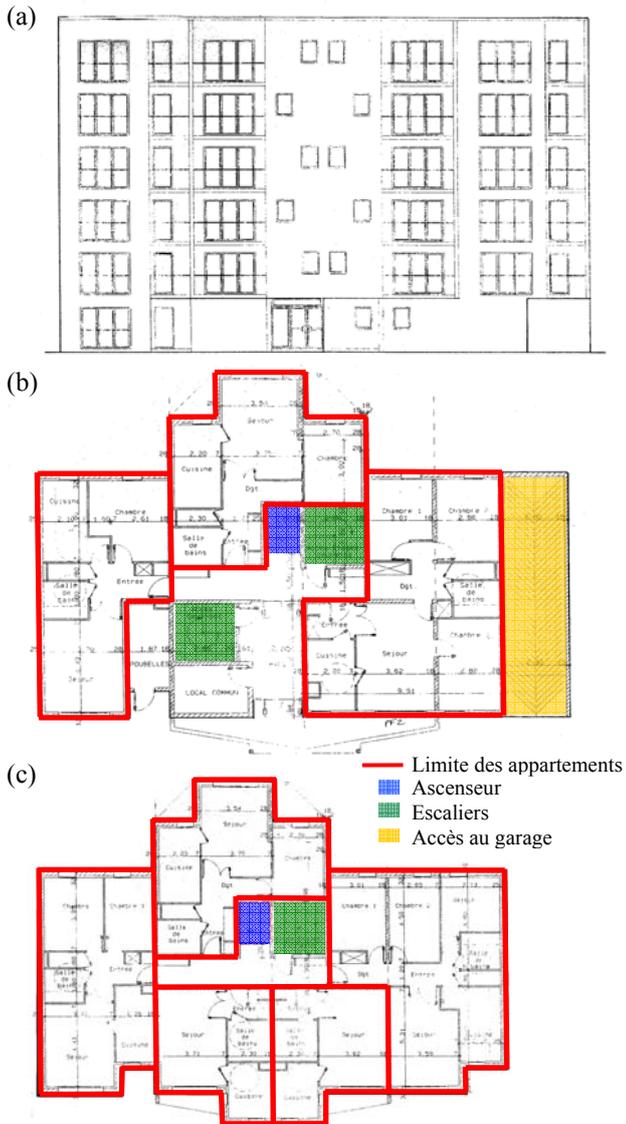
Bâtiment sélectionné ; (a) vue de la façade, (b) plan du rez-de-chaussée et (c) plan d'un étage courant.
